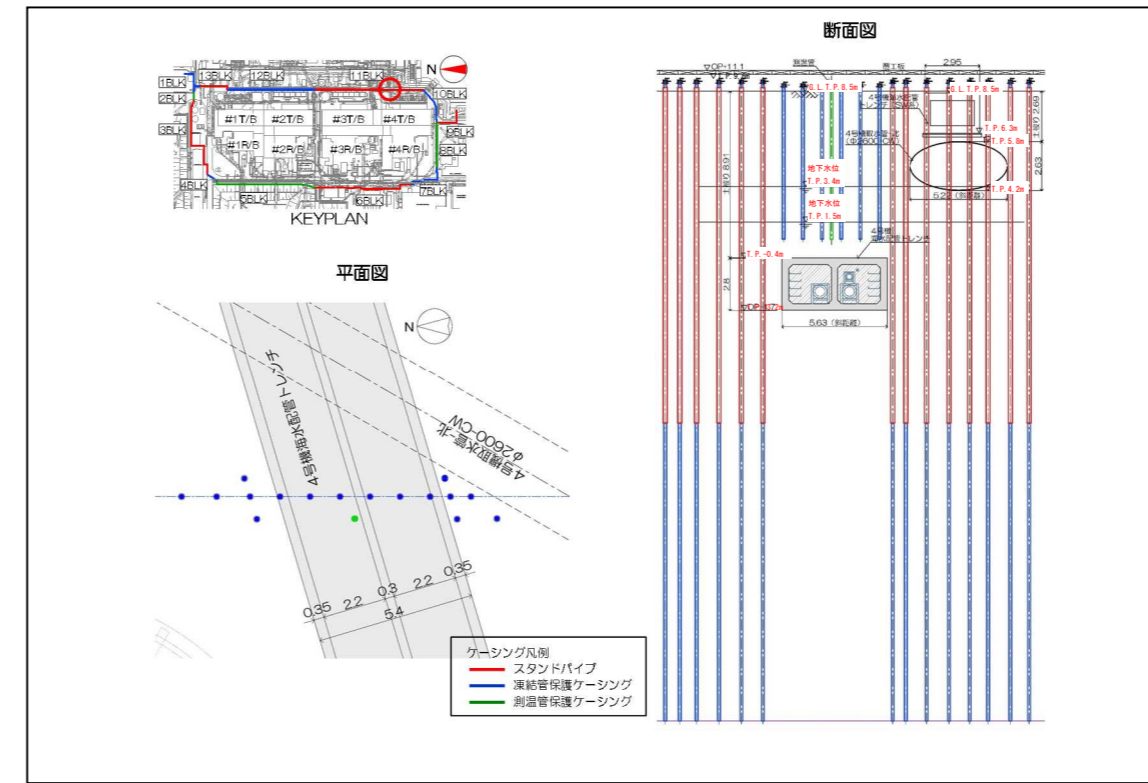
4号機海水配管トレンチ部 施工平面図・断面図
